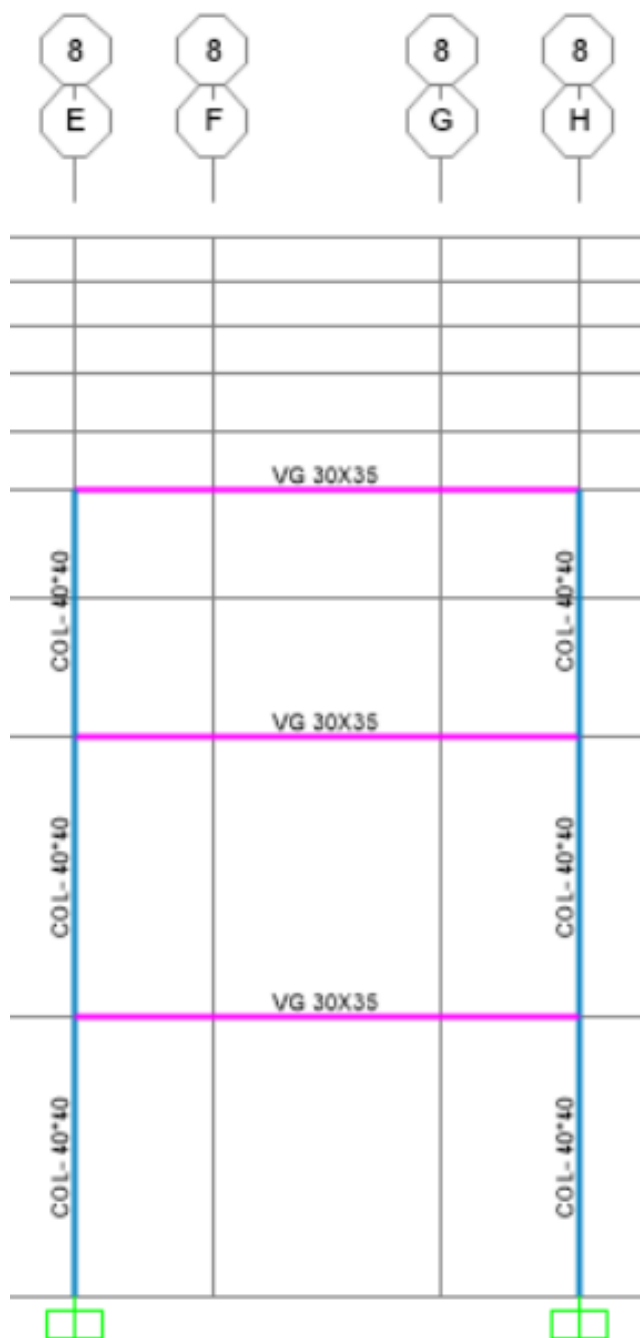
Pórtico de vigas 30x35 y columnas 40x40
